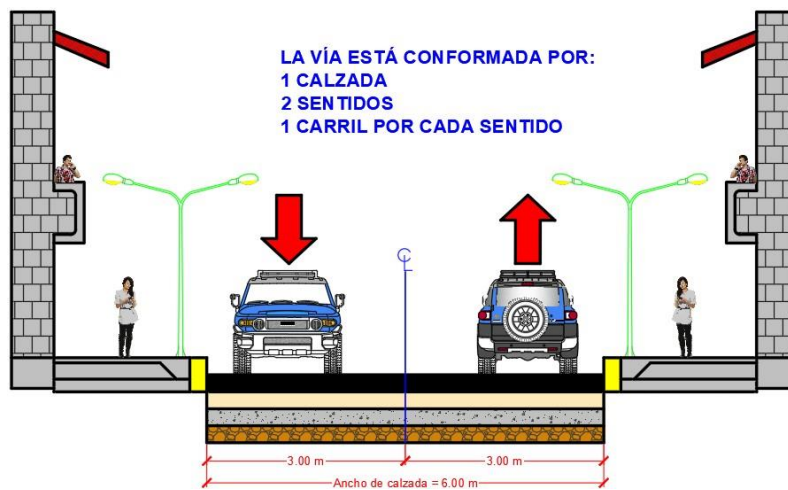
Dimensiones de del ancho de calzada de la vía
